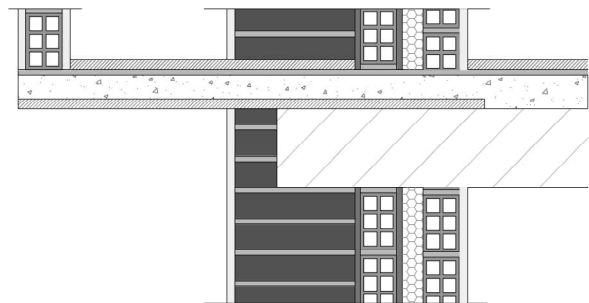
Fachada-Forjado (balcón). Zona oeste. Estado rehabilitado.
